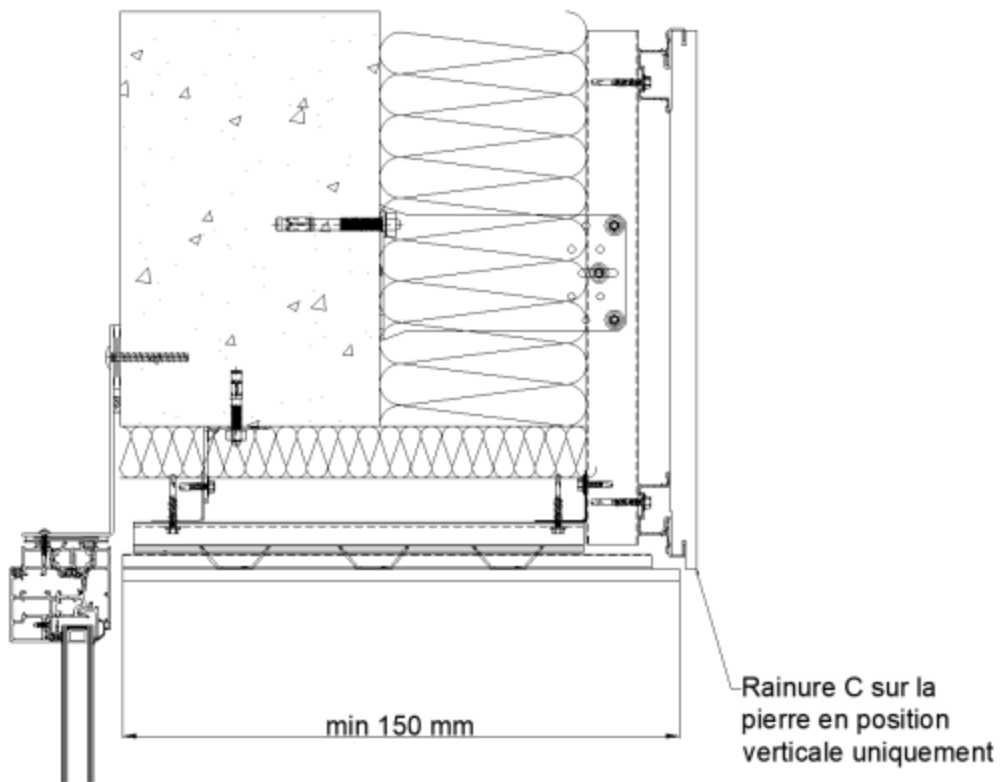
Linteau habillage pierre sur rail RV menuiserie en applique intérieure
